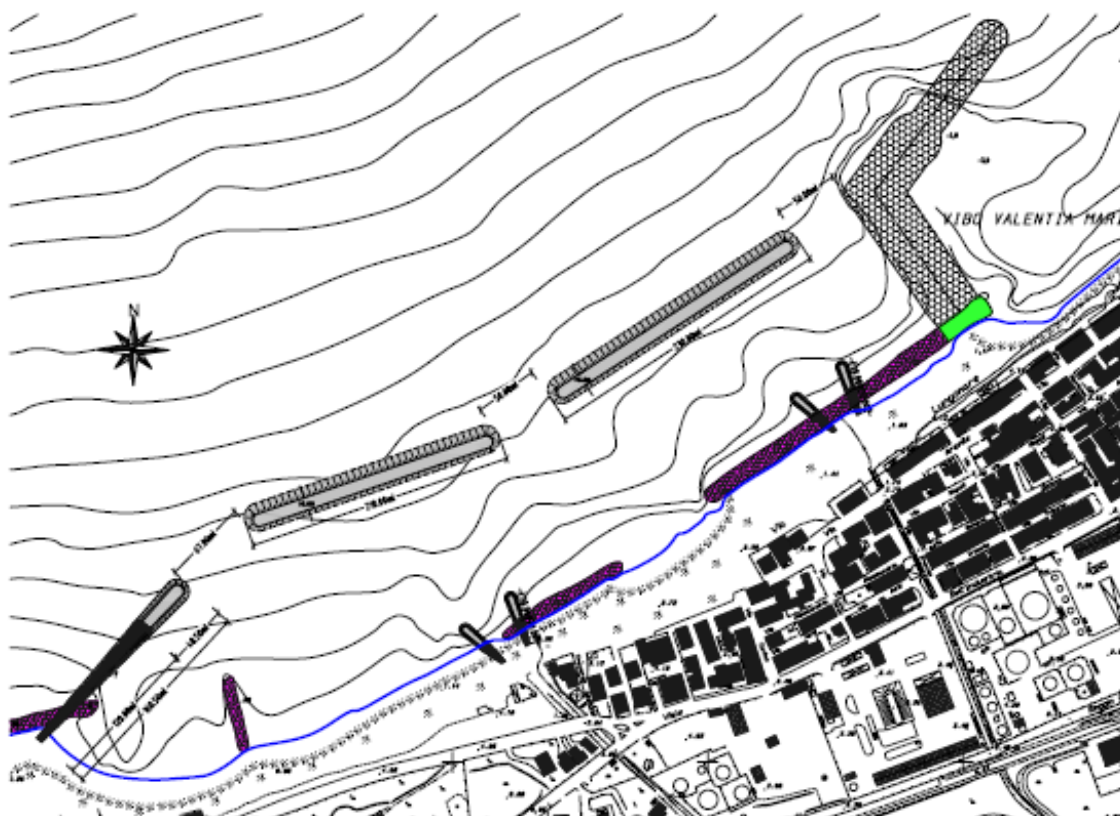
Progetto APQ – EC32 - Planimetria di progetto
